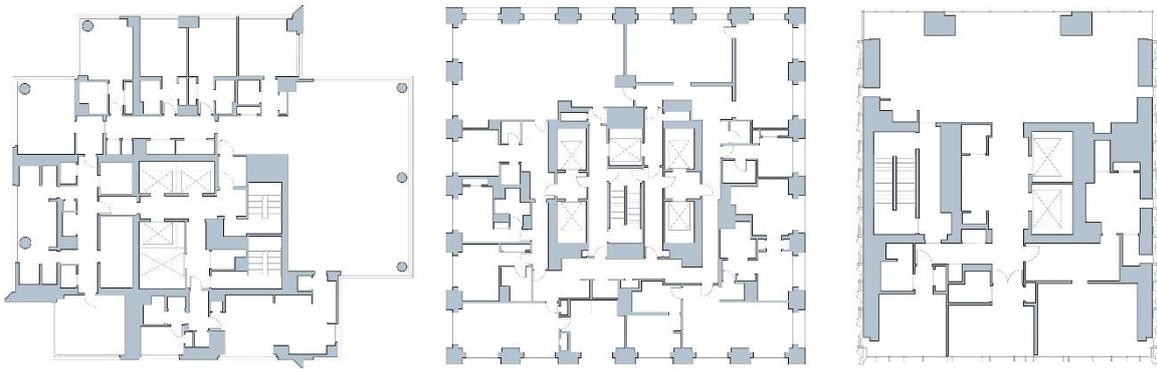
Central Park Tower, 432 Park Avenue y 111 West 57th Street. Plantas sin escala.
